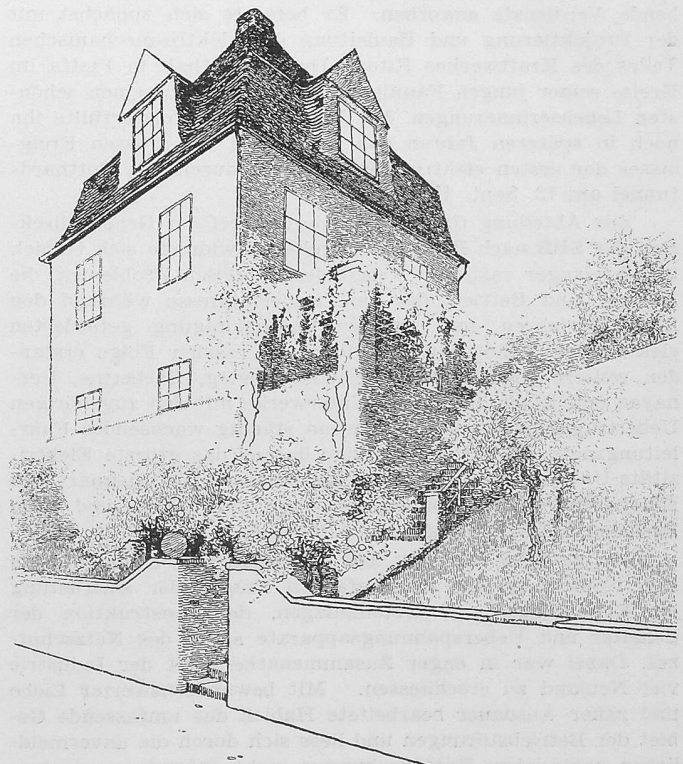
Entwurf zu einem bürgerlichen Wohnhaus am Bergabhang
